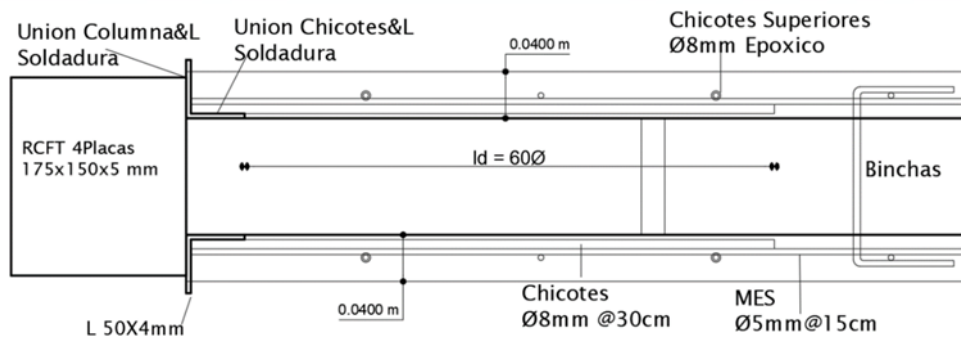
Esquema en planta de conexión entre columnas y enchape del prototipo I
